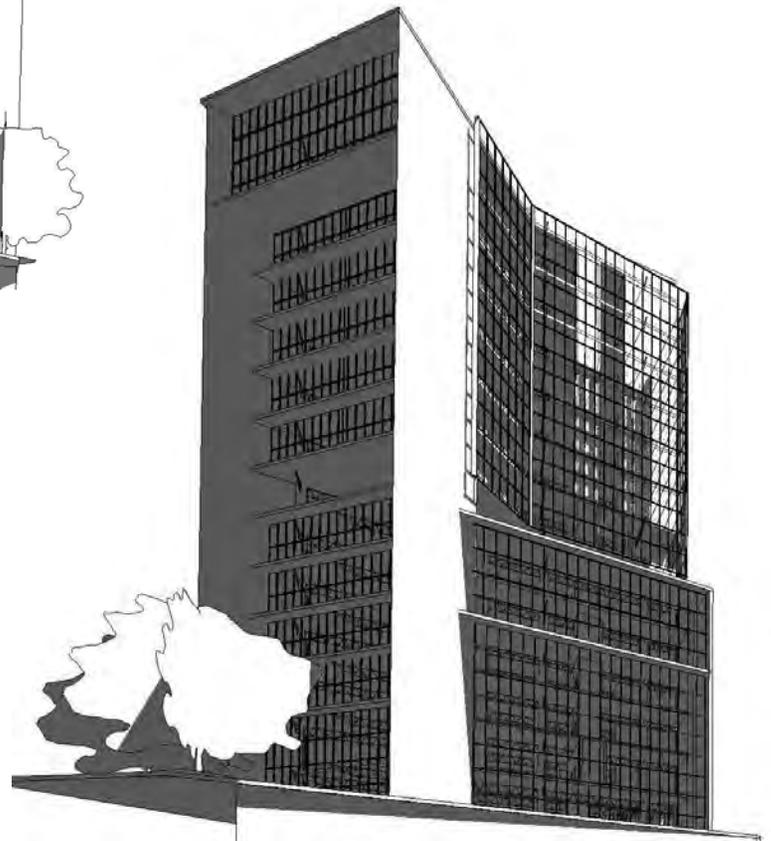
estudio de fachada de propuesta 6, vistas noreste y noroeste.
